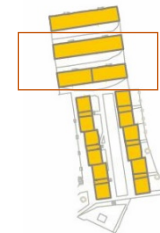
Indicación de las construcciones situadas en la Rúa Vilagarcía de Arousa, nº 6, 8, 10 y 12 en la parcela catastral (autoría propia).
